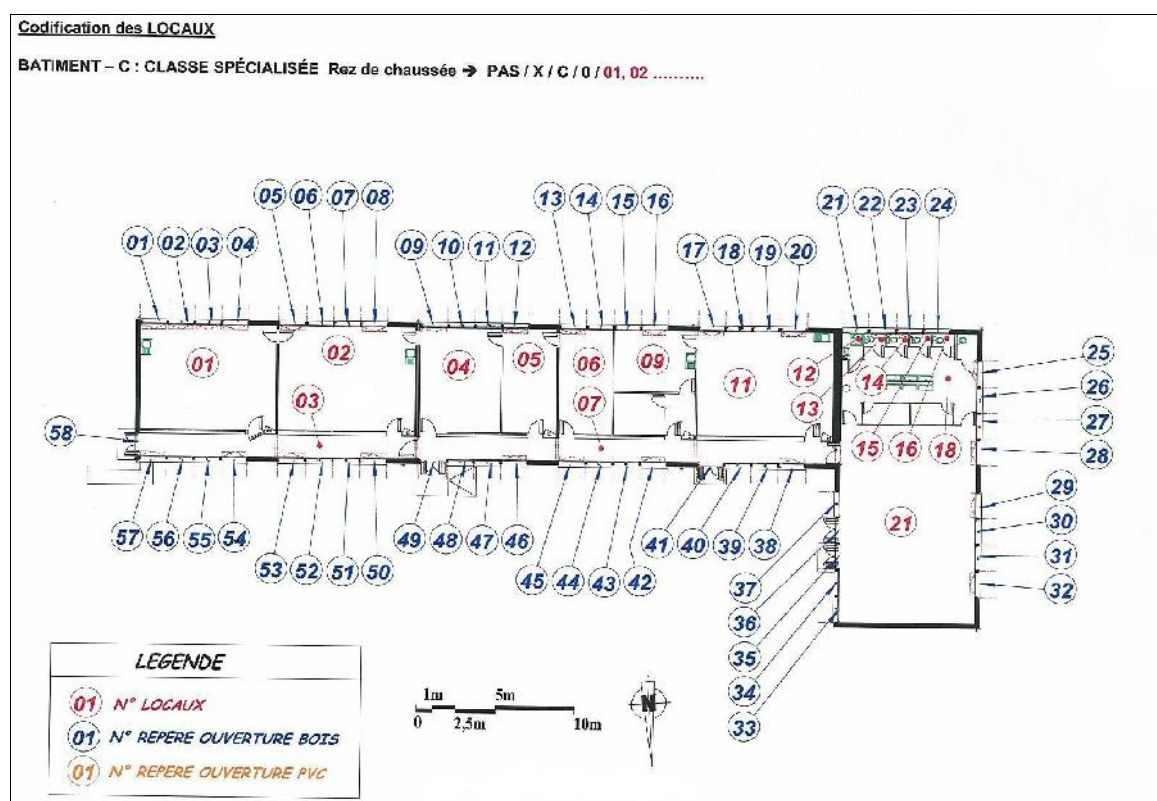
plan du bâtiment C (source : mairie de Niort - les repères des ouvertures ne sont pas à jour sur ce plan.)
